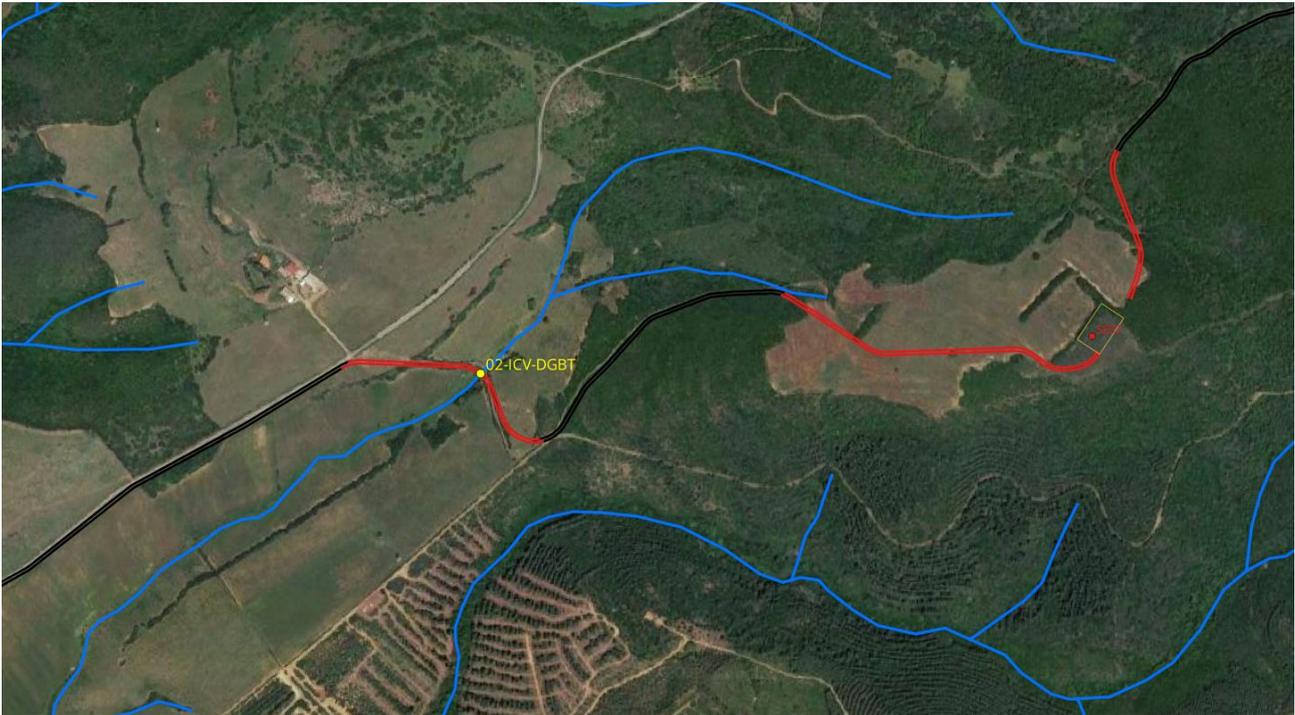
Planimetria attraversamento 02-ICV-DGBT
